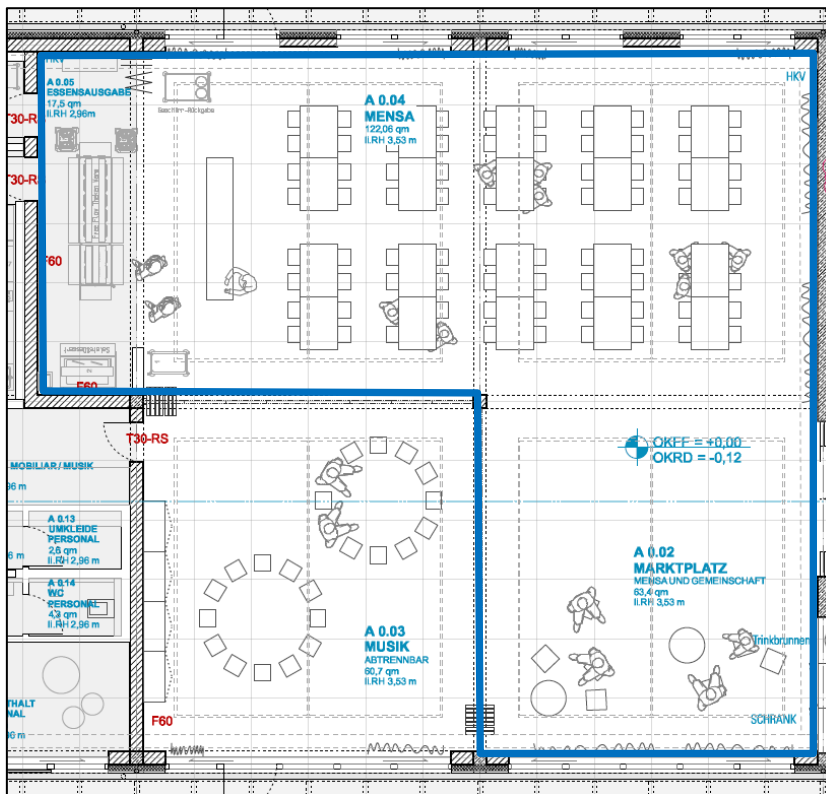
Grundriss Mensa + Marktplatz, unmaßstäblich /13/
